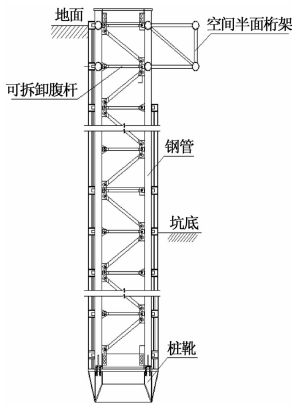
钢桁架式基坑支护结构与围护墙垂直的剖面图
